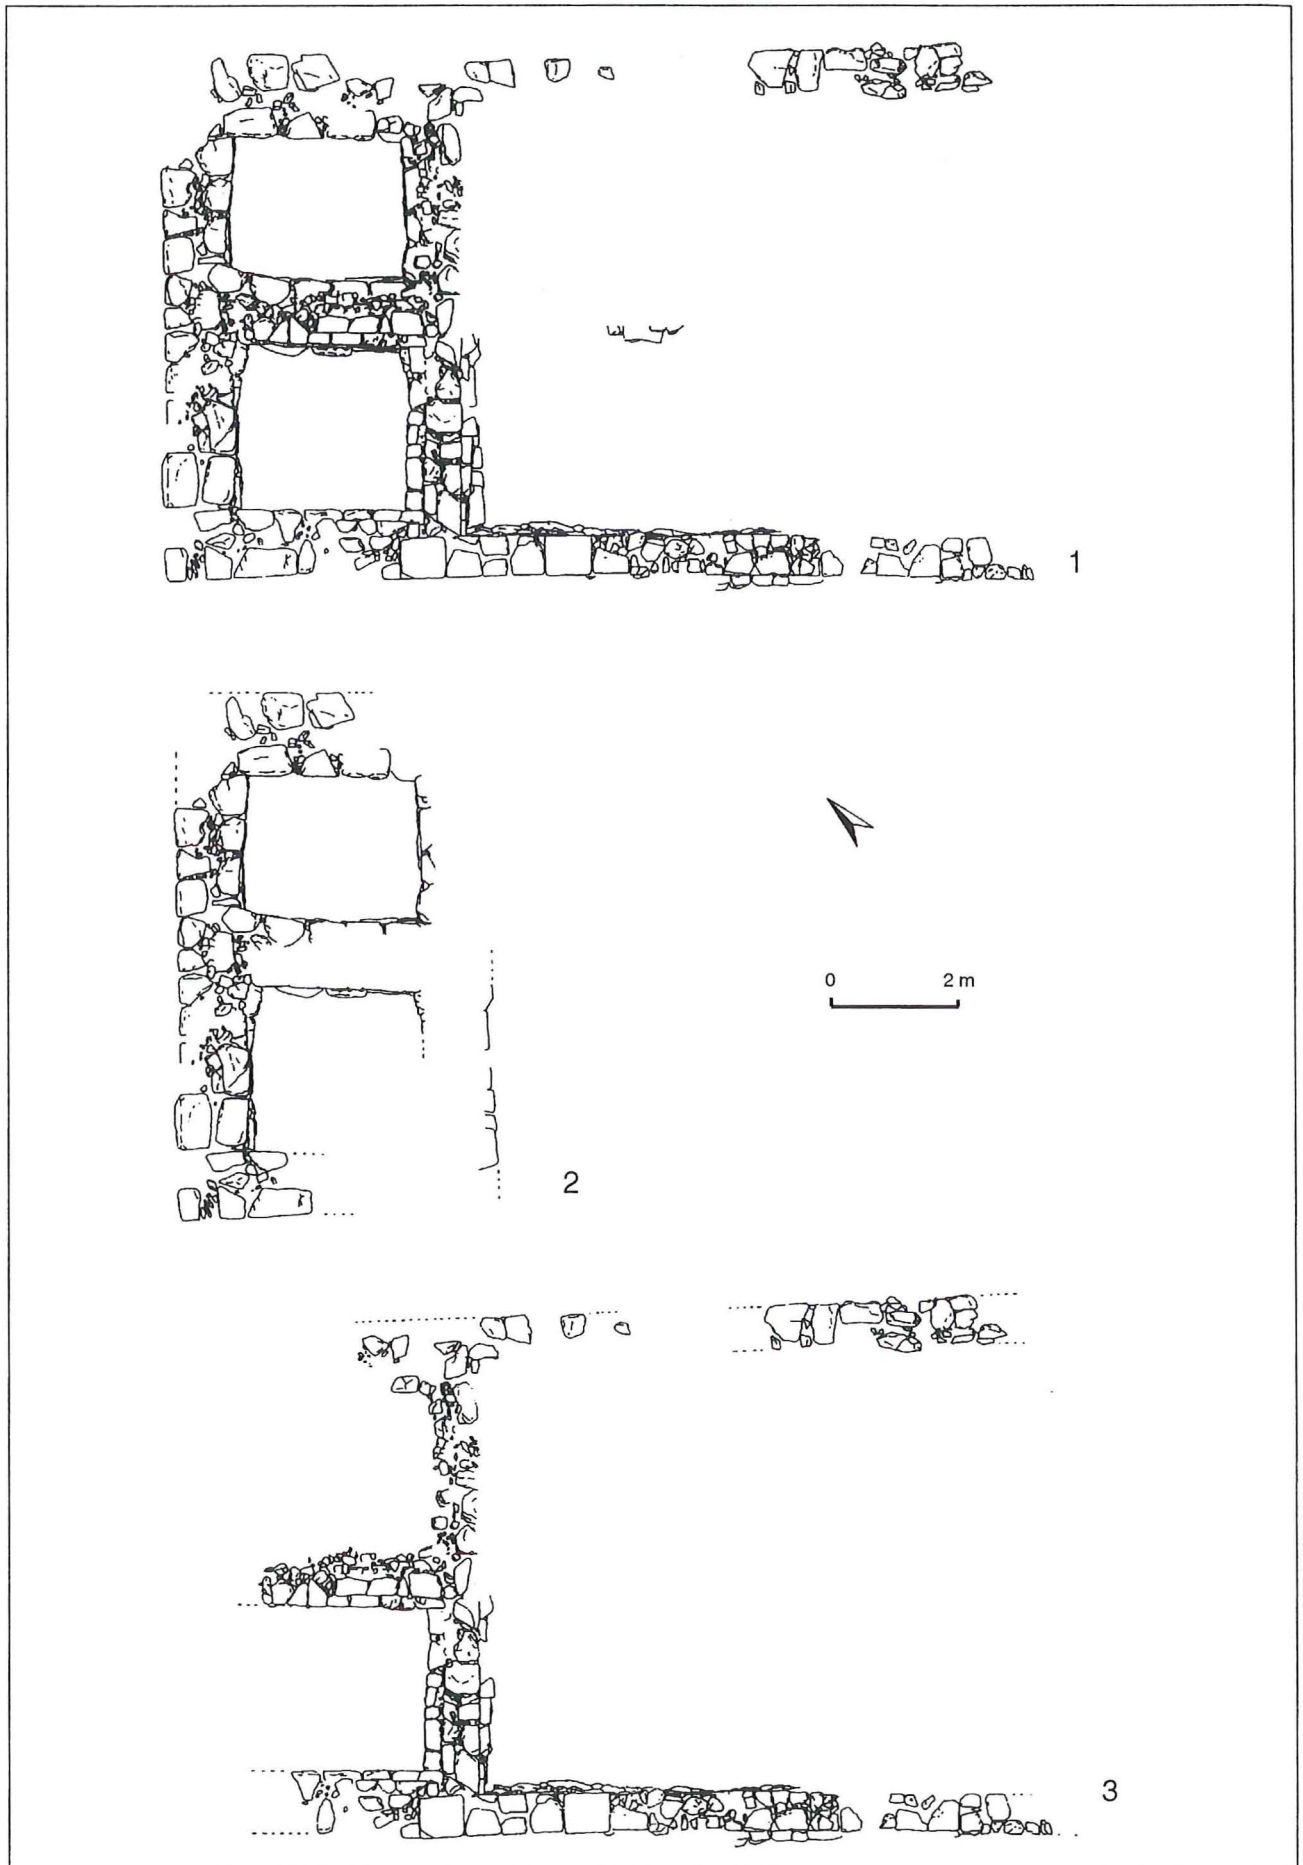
1. Planta del “Edificio A”. 2. Planta de la “Construcción I/Torre 1”. 3. Planta de la “Construcción II/Edificio A”.
